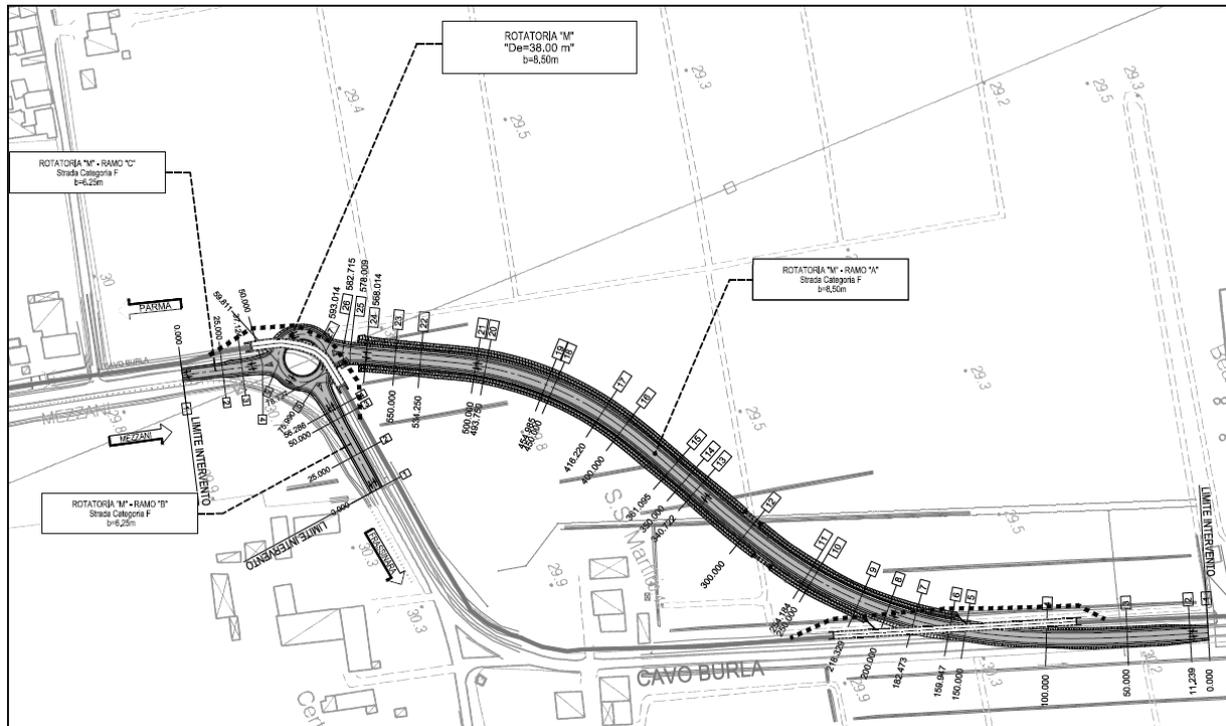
PLANIMETRIA DI PROGETTO – TRATTO 1
